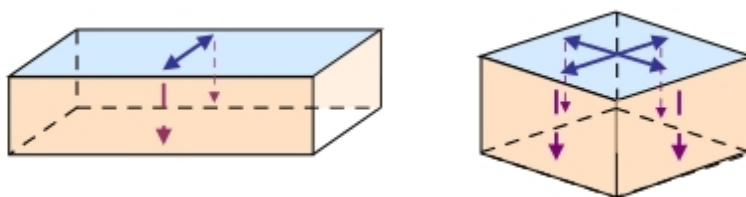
Planchers sur 2 et 4 appuis
